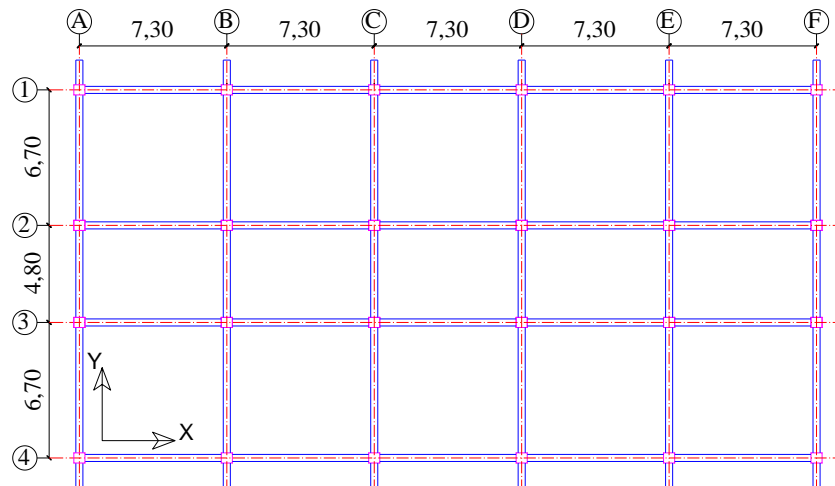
Vista en Planta, Bloque A, Edificio Residencia.
